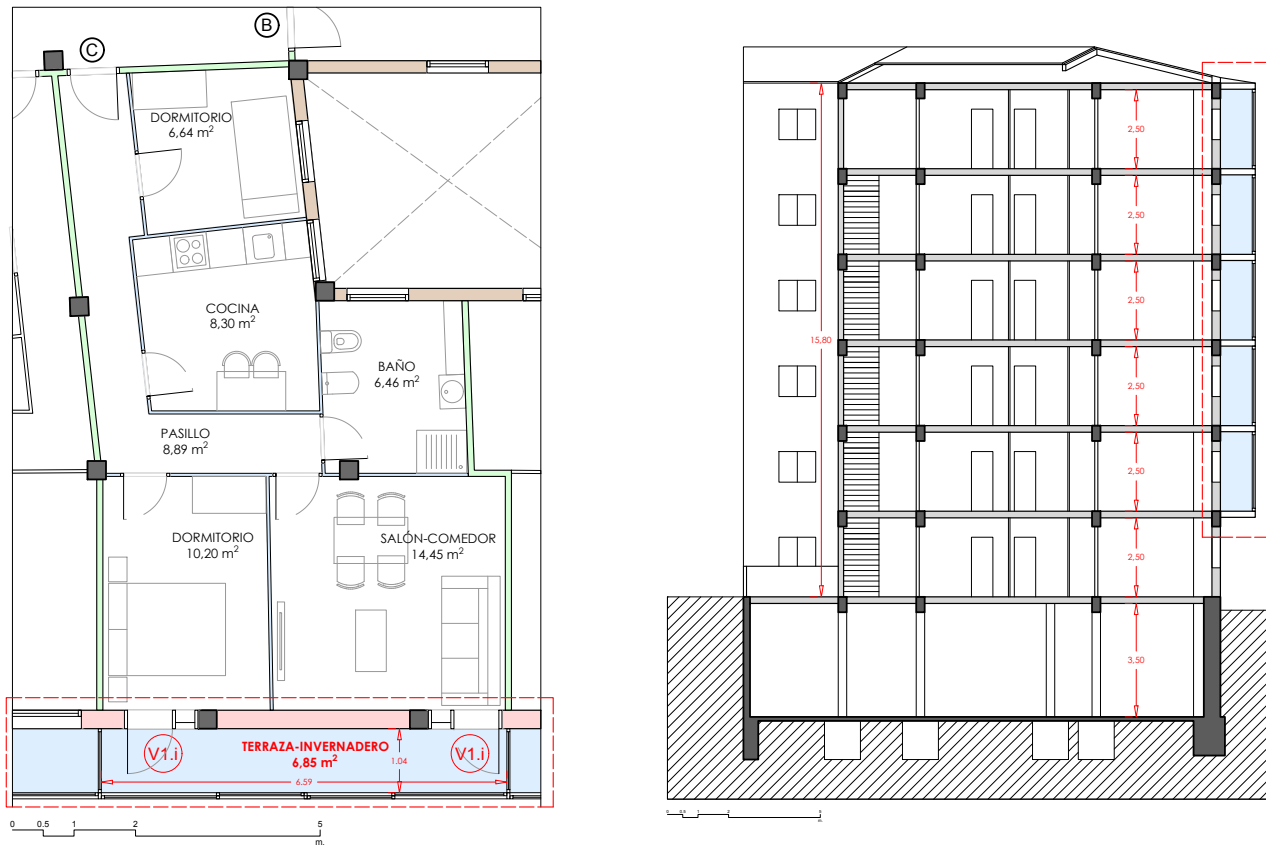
Planta de la vivienda de estudio y sección del edificio, más invernadero
